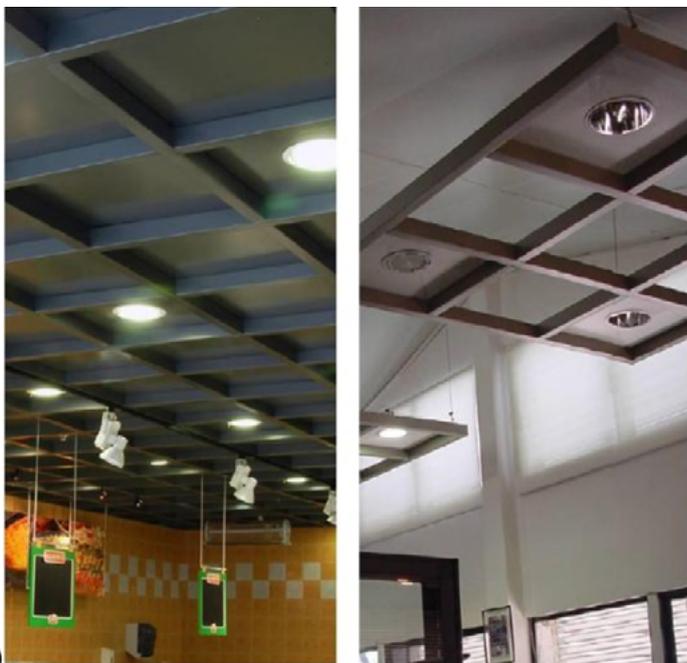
FORRO MODULAR REMOVÍVEL
